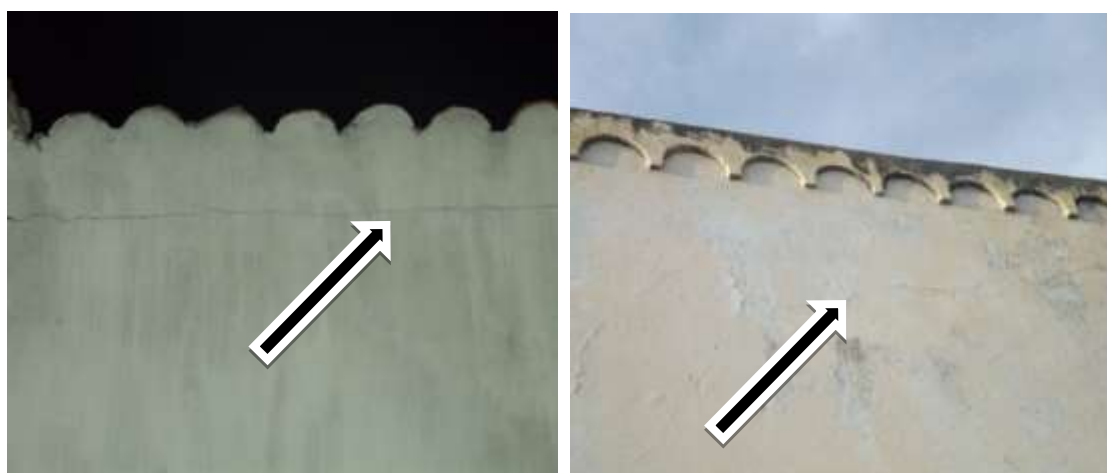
Fissuras horizontais causada por movimentação térmicas
